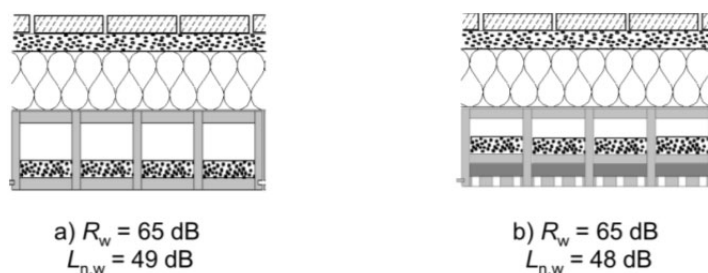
Flachdächer aus Massivholz-Kastenelementen, EPS Aufdachdämmung, Dachabdichtung und Betonplatten im Kiesbett:
